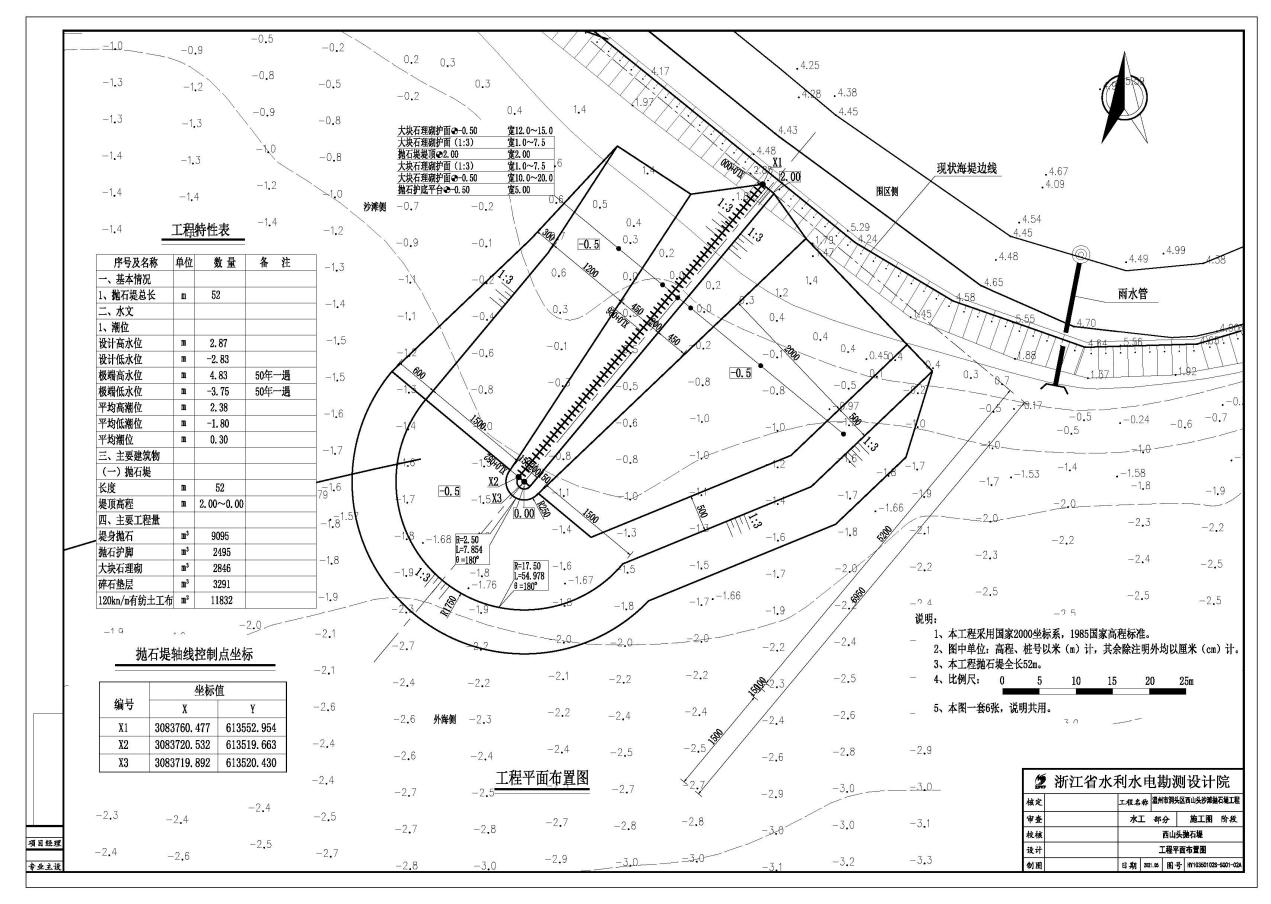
西山头沙滩建设工程抛石堤平面布置图
